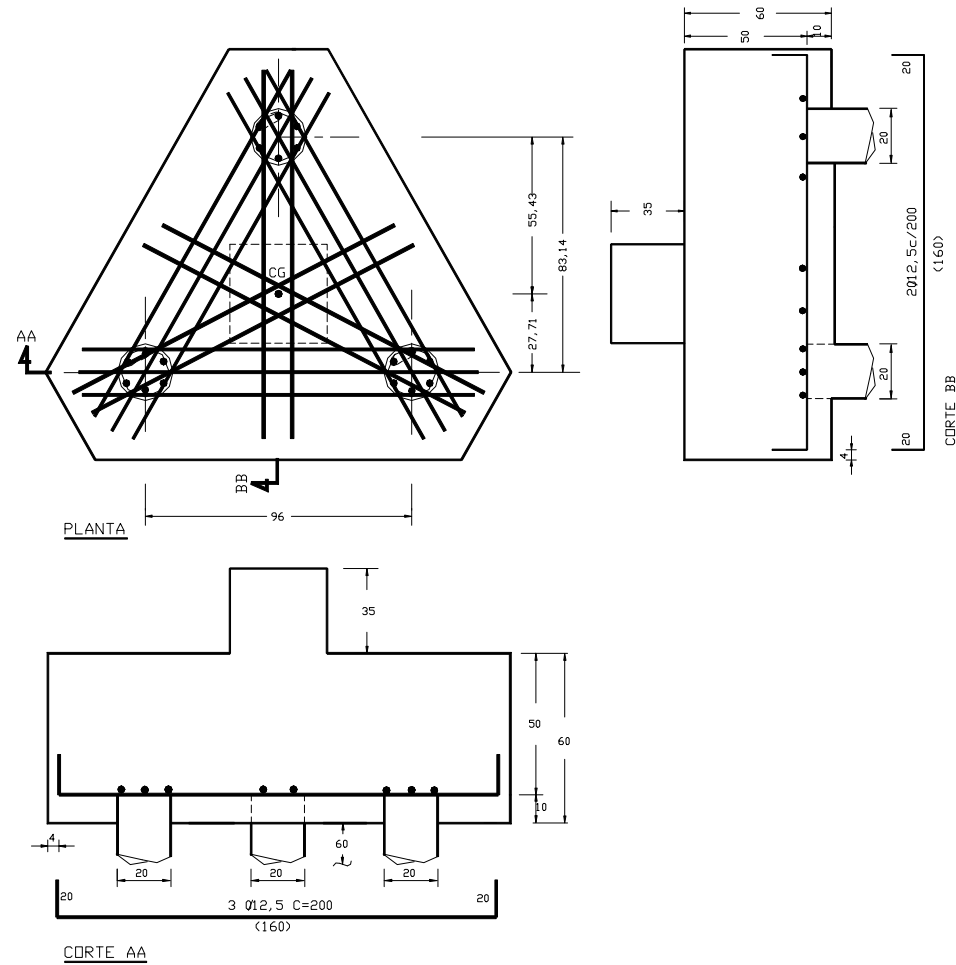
Armadura principal e armadura passando pelo pilar (D = 20 cm)
